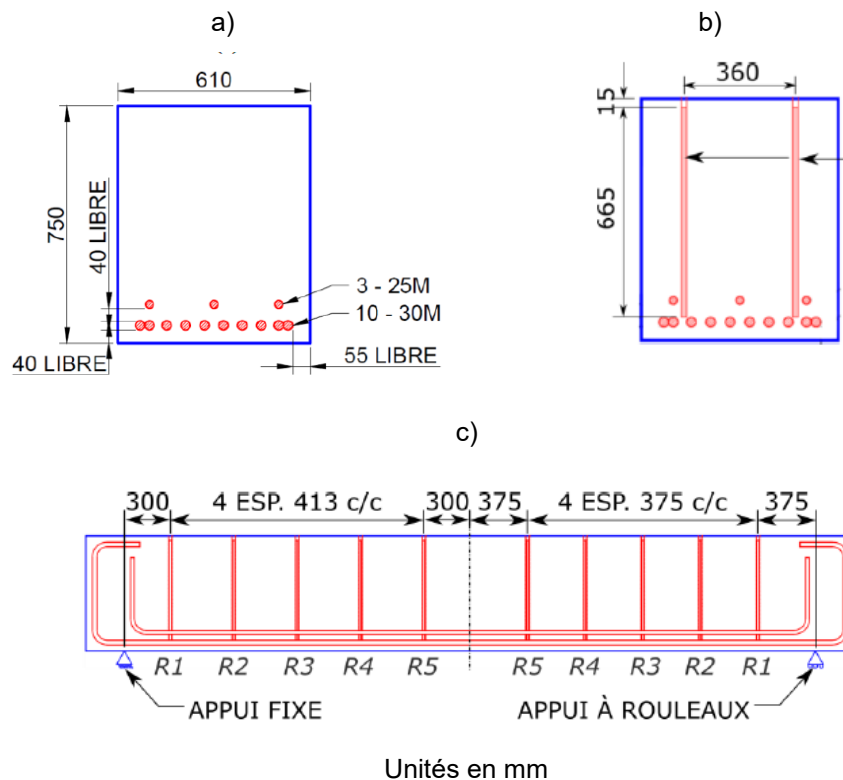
Représentation des poutres testées par Bédard (2019), a) vue de la section sans renforcement transversaux et (b) avec barres ETS collées, et (c) vue en élévation d'une poutre renforcée de barres ETS (adaptée de Bédard, 2019)
